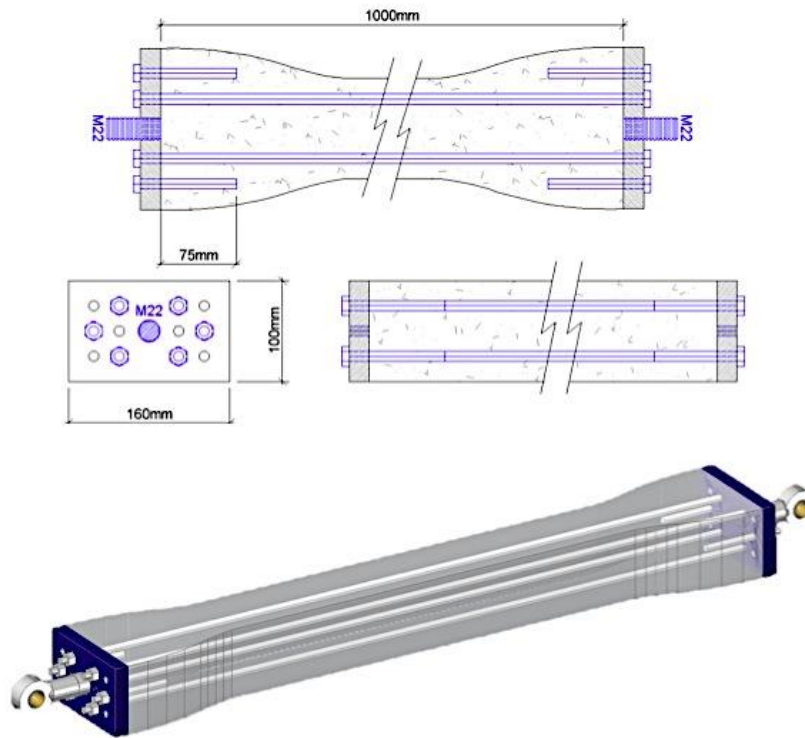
Desenho esquemático do provete de betão armado utilizado por De Sousa (2011)
